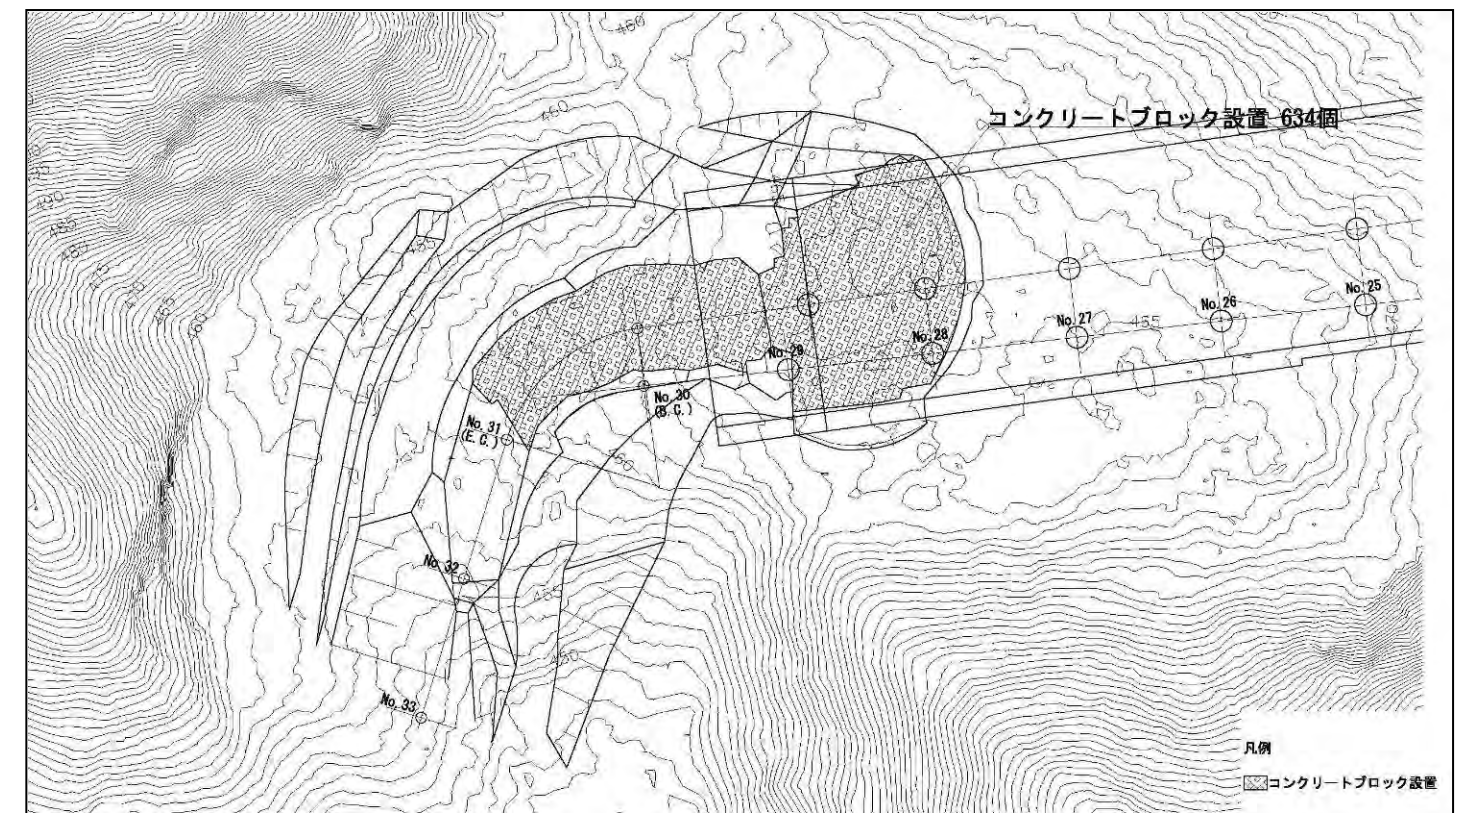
栗平地区コンクリートブロック設置平面図（台風4号による洗掘復旧対策）
